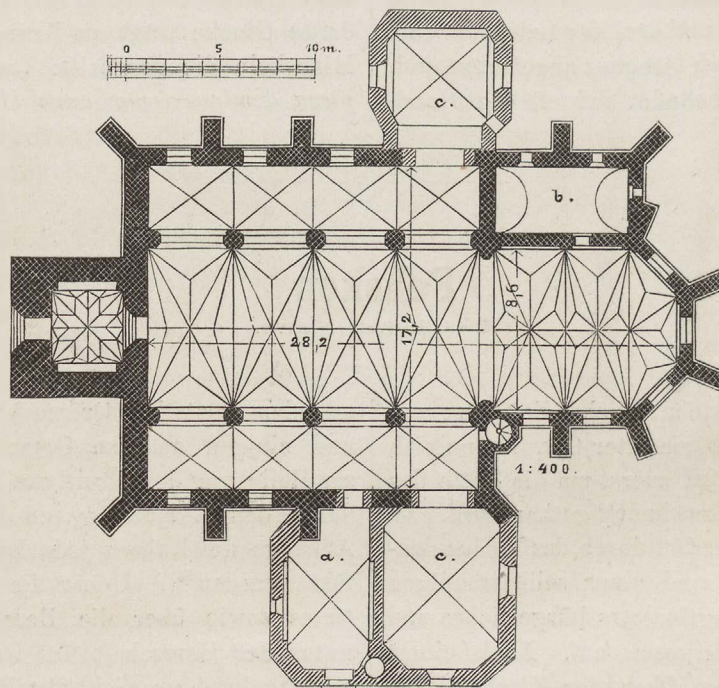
Grundriss der Kirche in Pehsken.
